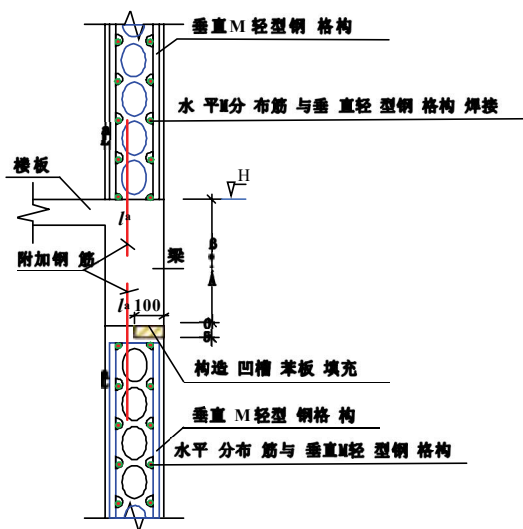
M 型钢成型钢筋骨架剪力墙上下层连接构造示意
